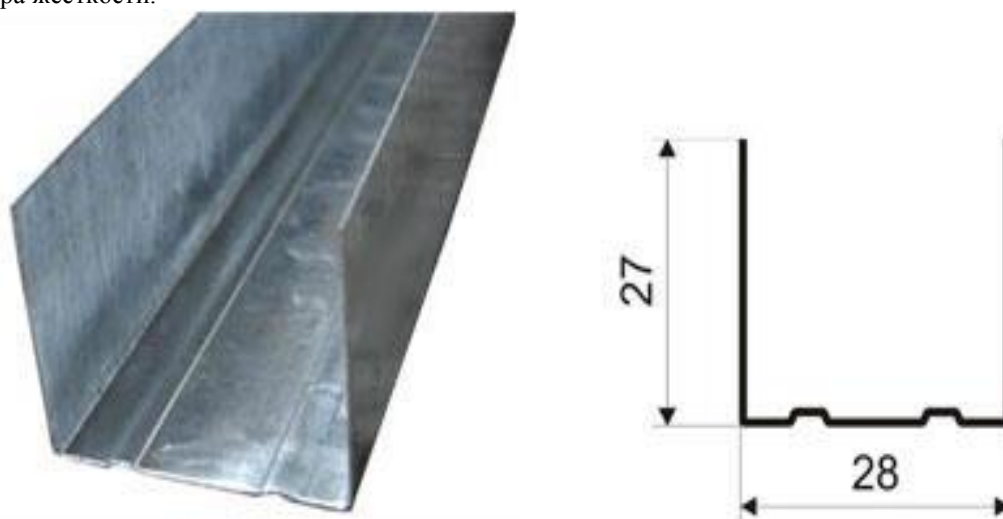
Профиль потолочный направляющий 28*27мм
